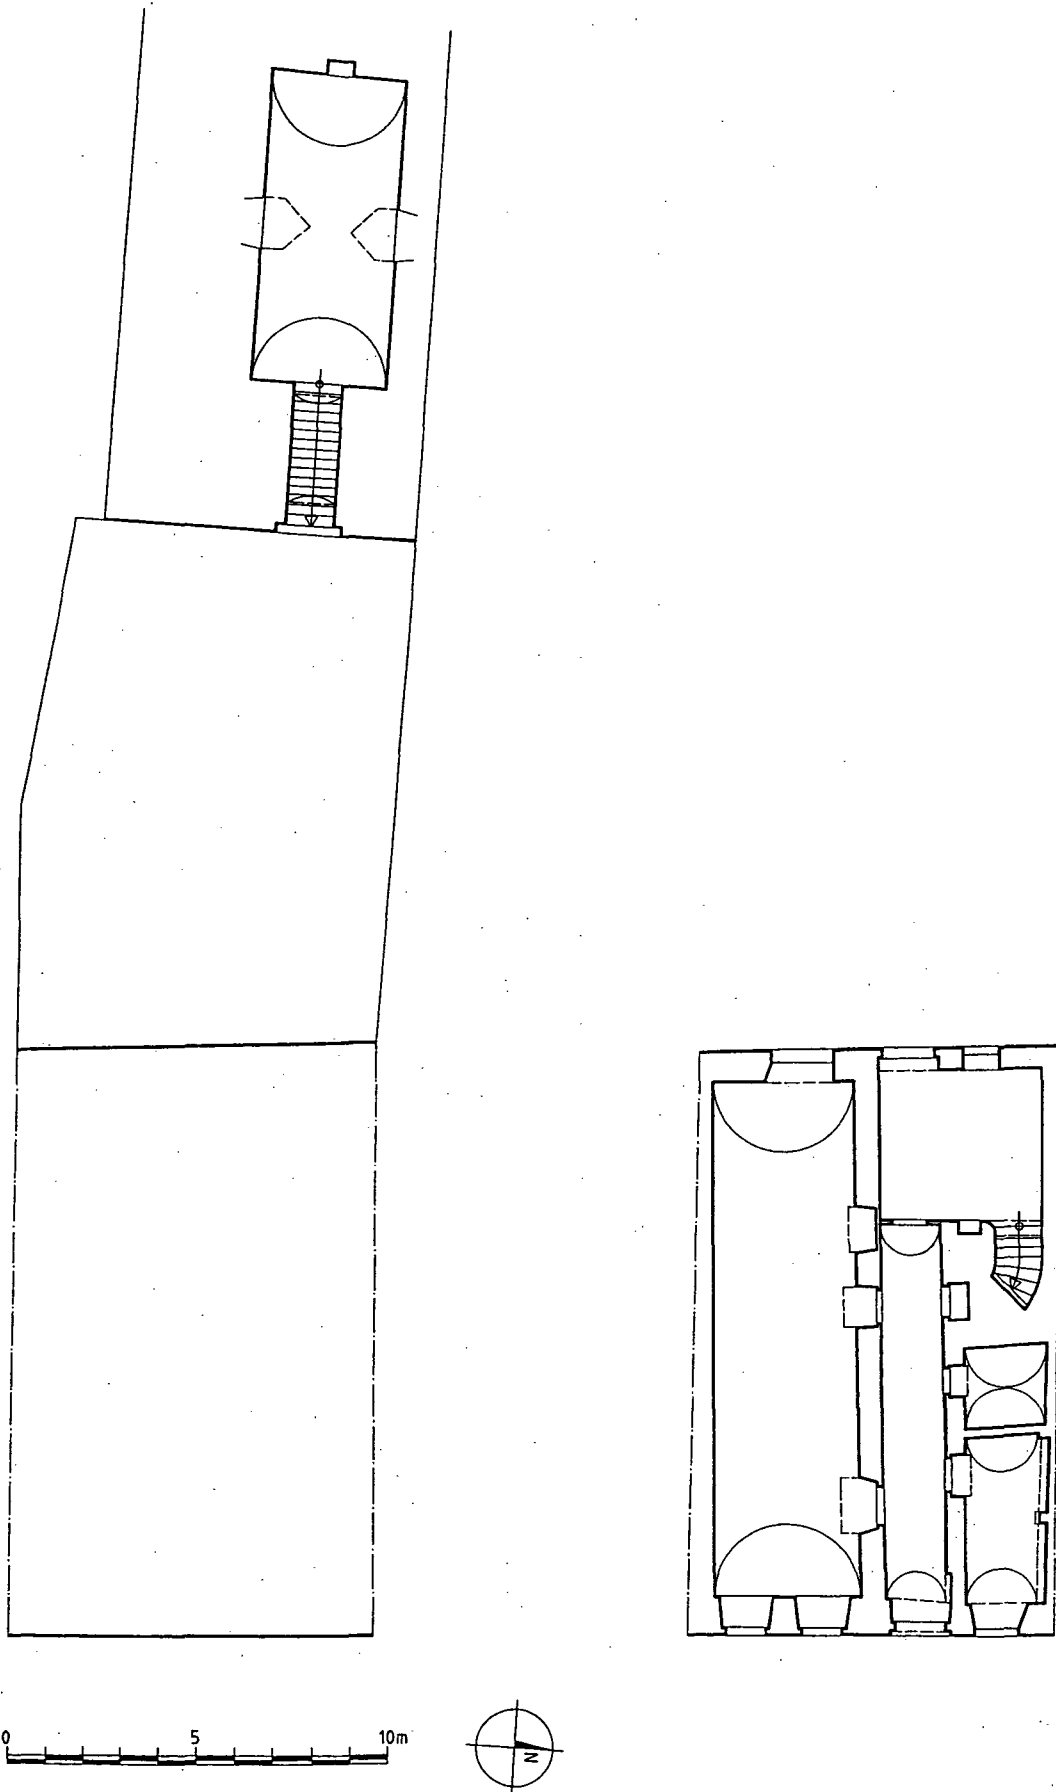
Schiferplatz 20 – Grundrisse Keller, Erdgeschoss (1:200).
